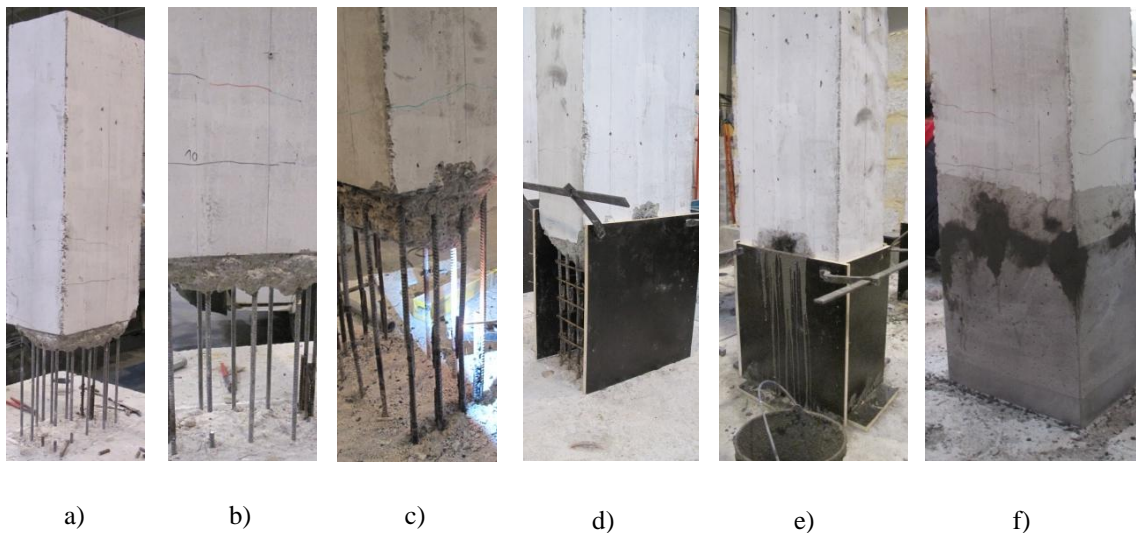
Processo de reparação da armadura transversal dos pilares: a) delimitação da área de reparação; b) Remoção e limpeza do betão e das armaduras danificadas; c) Colocação de armaduras longitudinais adicionais soldadas às existentes; d) Aplicação da cofragem de madeira; e) micro betão pré misturado modificado; f) Aspeto final do pilar (LESE, 2014).
